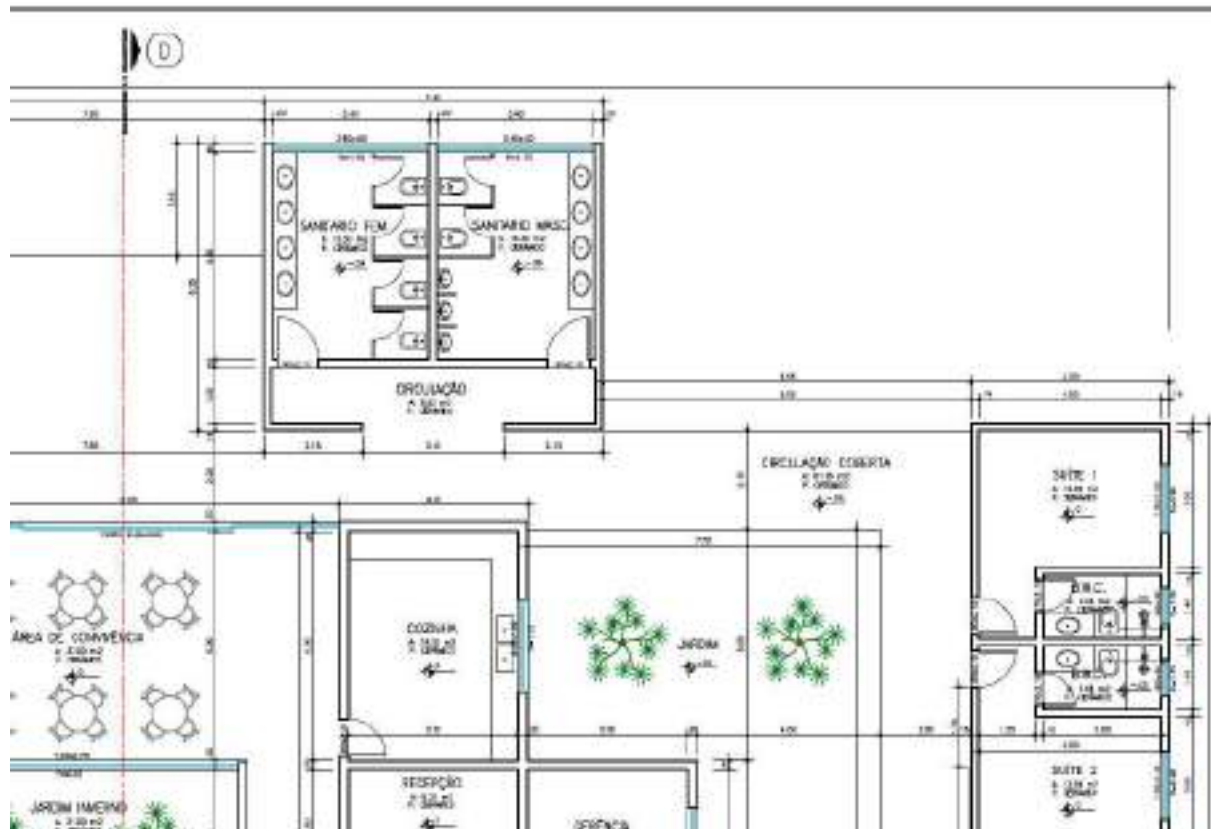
Partes da planta baixa geral da infraestrutura do velório.
